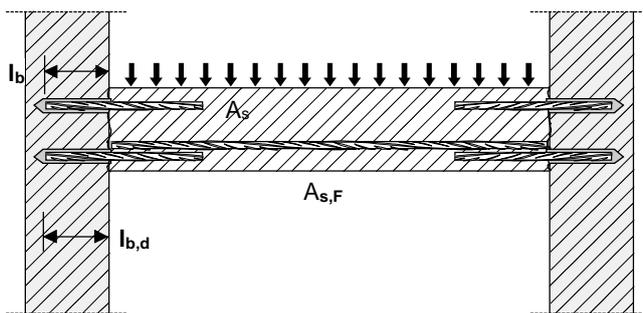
Ancrage direct d'armatures en extrémité de dalles ou poutres, simplement appuyé.
